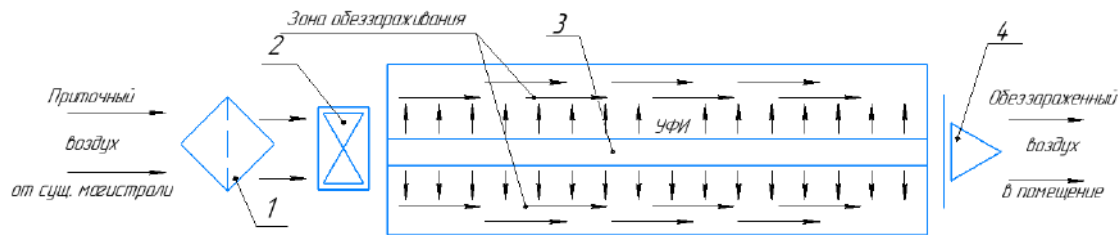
Установка обеззараживания приточного воздуха в системе вентиляции помещения: 1-фильтр; 2 – вентилятор; 3 – УФИ; 4 – дефлектор приточной вентиляции помещения
